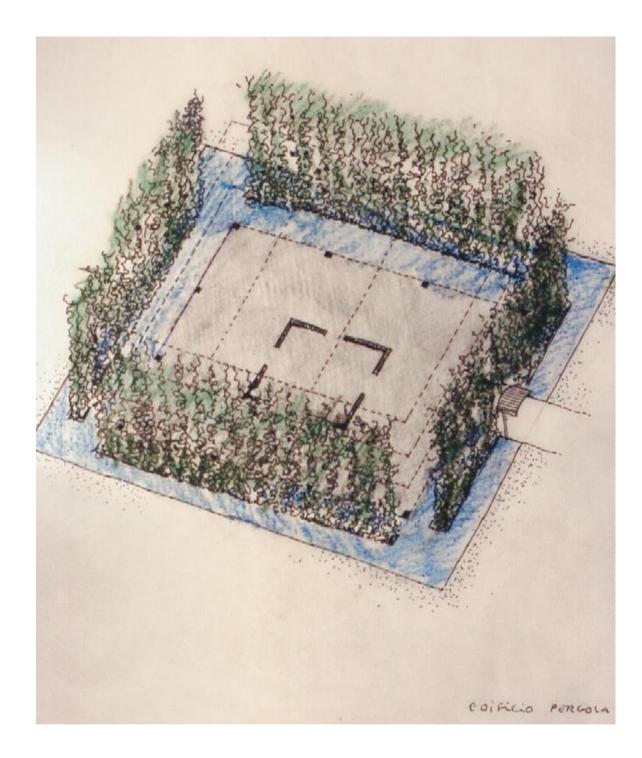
Esquema de empleo del sistema de fachada vegetal y perfil húmedo al contorno de la planta baja del edificio.
